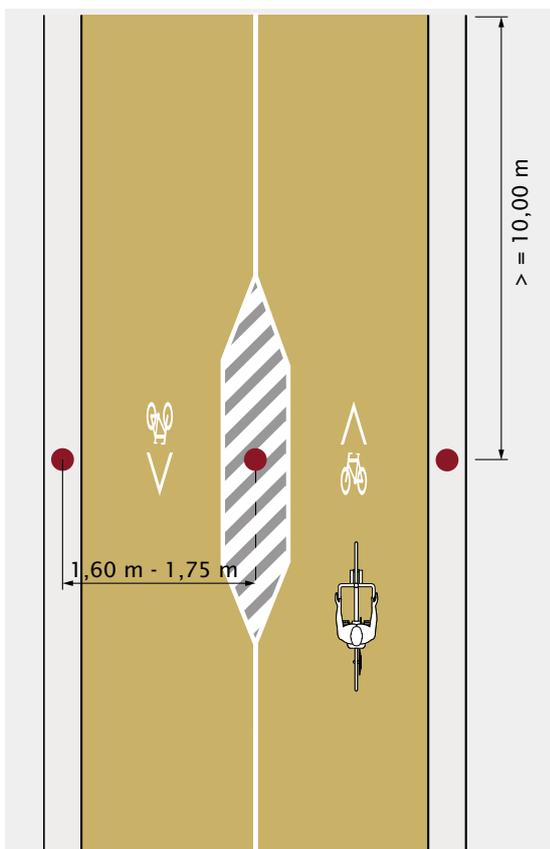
Le positionnement d'un poteau sur un îlot central.
